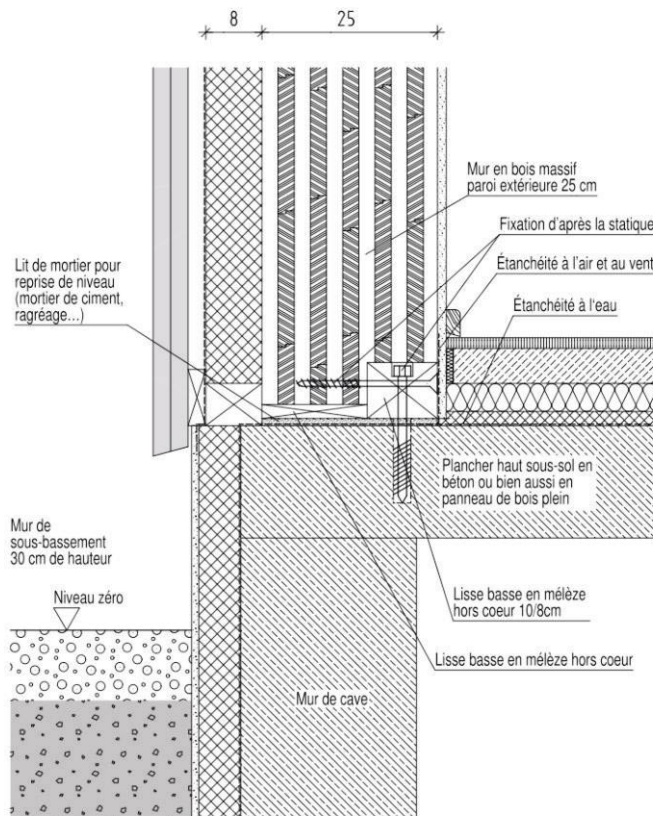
Coupe verticale de l'ancrage mur/fondation
